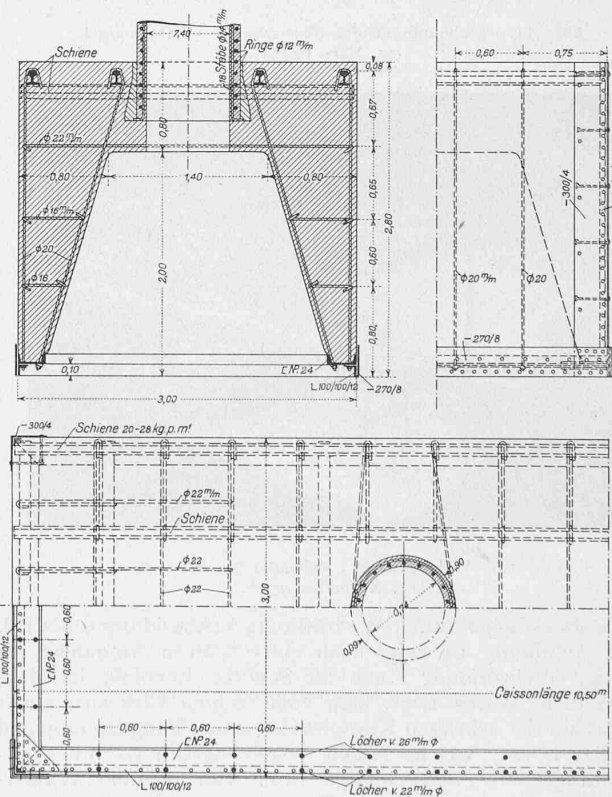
Eisenbeton-Caisson von  $10,50 \text{ m}$  Länge; Querschnitt, Stirnansicht, Draufsicht und Grundriss der Schneide. Masstab 1:60.
